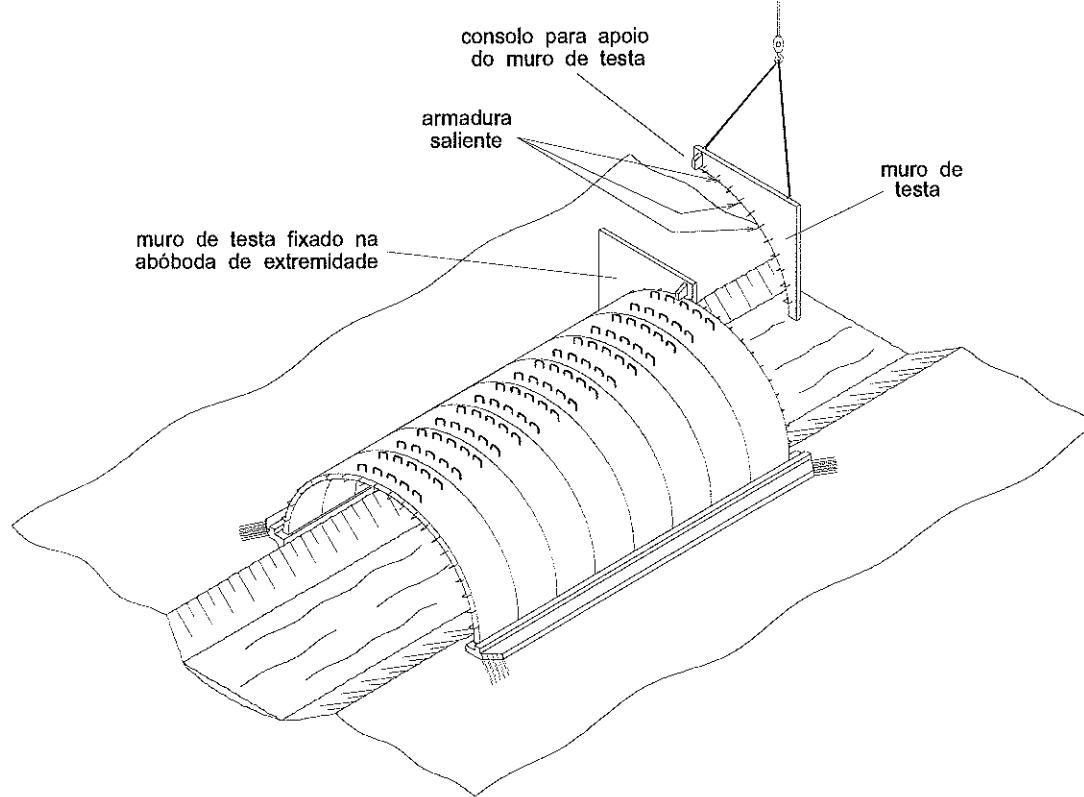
Colocação dos muros de testa de concreto pré-moldado apoiados na fundação e nas abóbadas de extremidade
